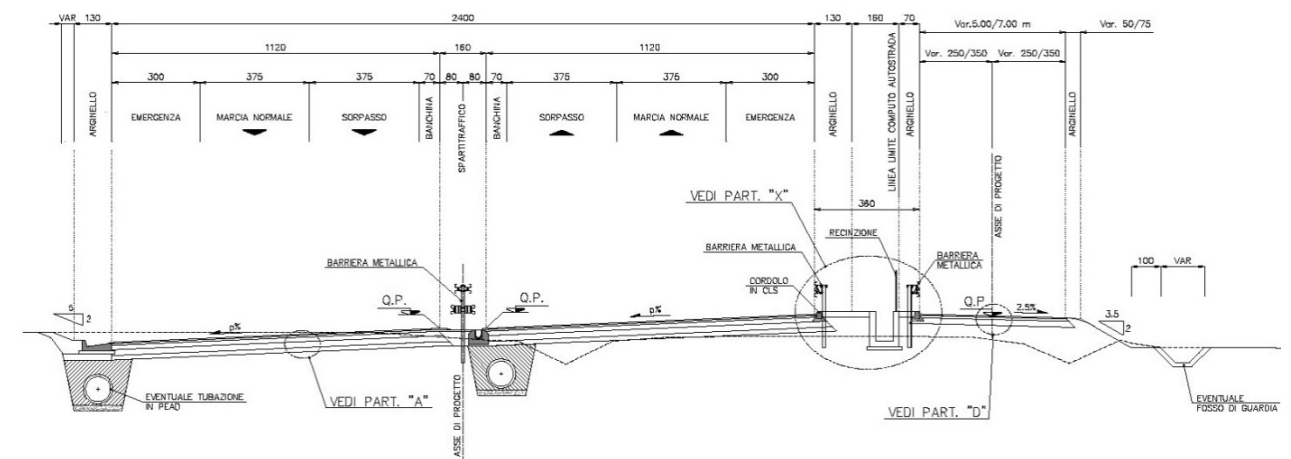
Sezione tipo di progetto con viabilità secondaria in complanare (adeguamento SS1 Aurelia)
